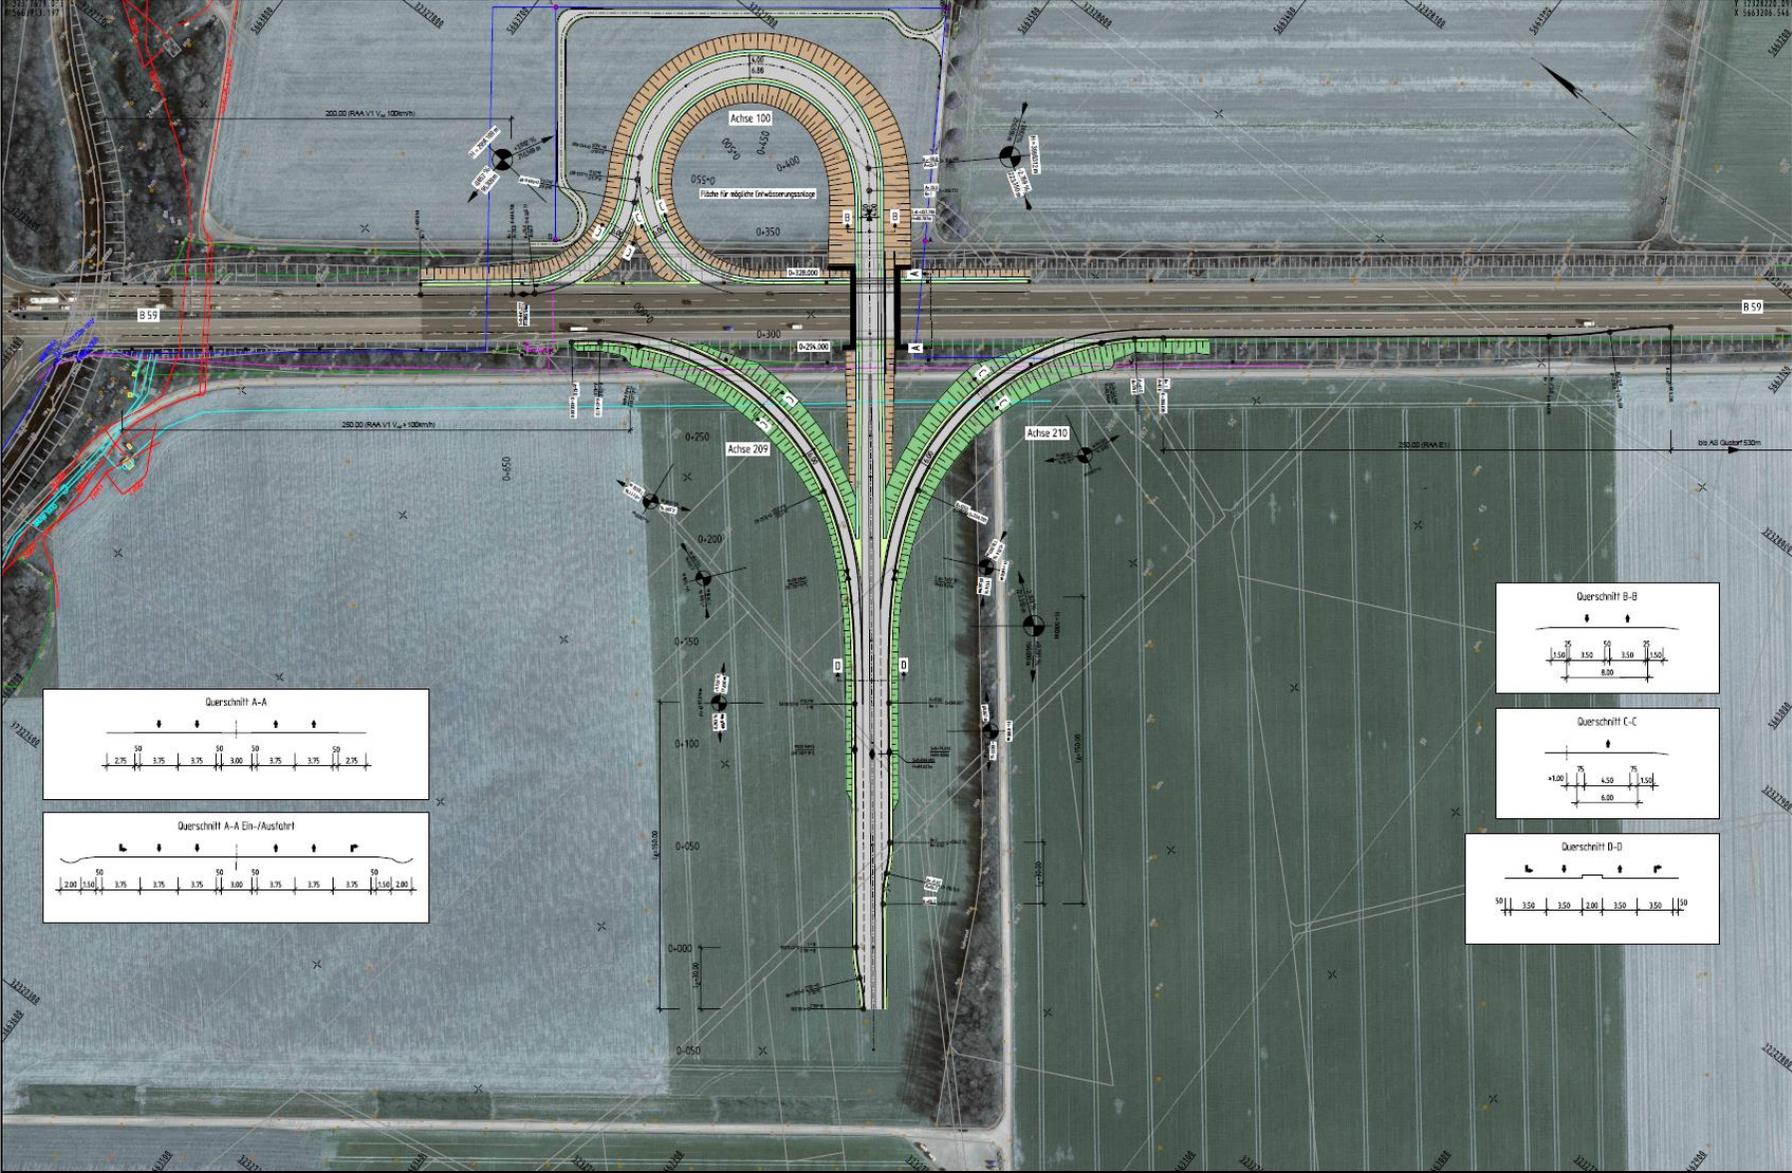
Straßenplanung zum Bebauungsplan „Industriepark Elsachtal“
